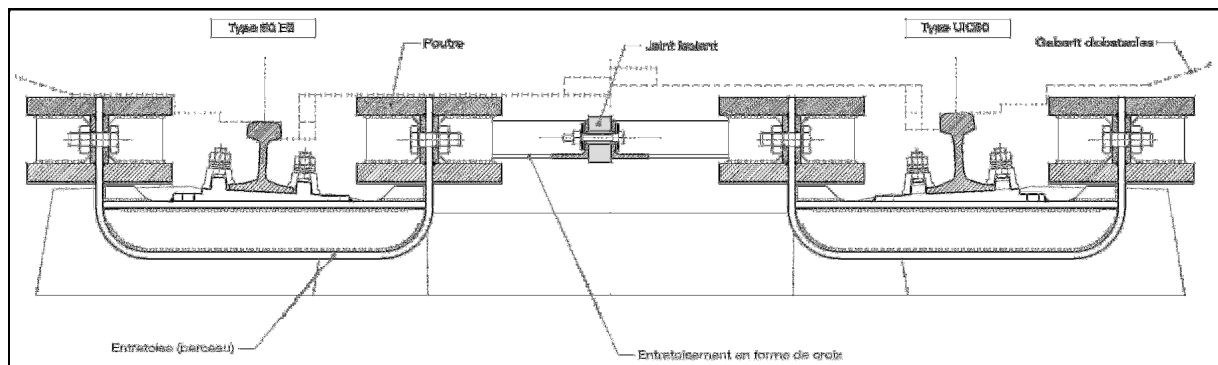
Coupe transversale d'un renforcement de voie de 7,20 m
